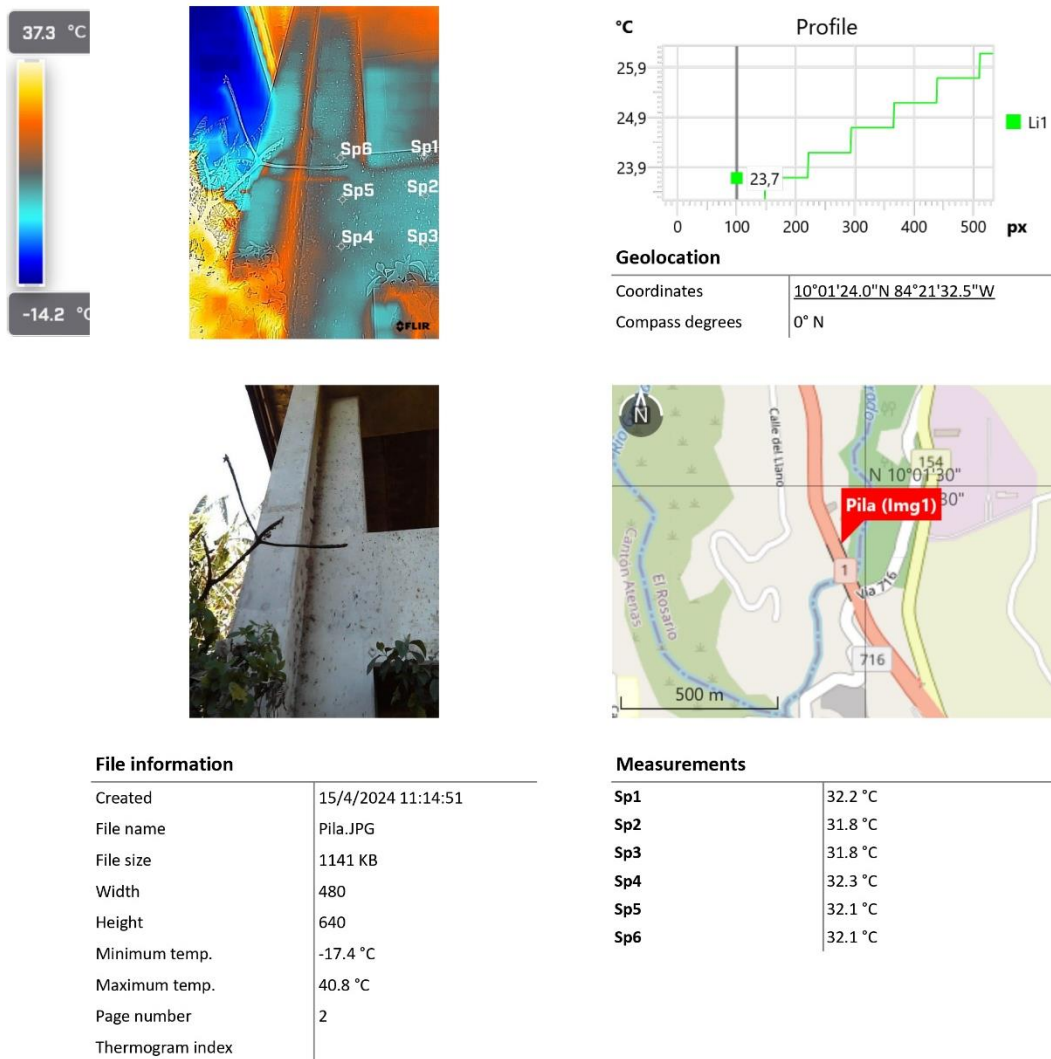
40 Reporte térmico de grietas en cuerpo principal (pila) de la sección No. 9
